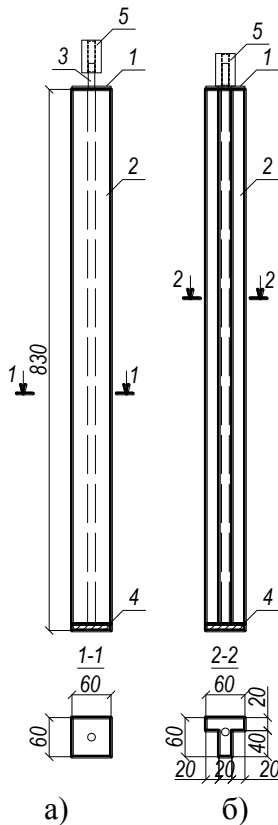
Моделі дослідних паль-штампів квадратної (а) і таврової (б) форми поперечного перерізу; 1 - металевий оголовок палі; 2 - дерев'яна бічна поверхня; 3 - шпилька; 4 - торець приварений до шпильки 3; 5 - металевий кругляк.
